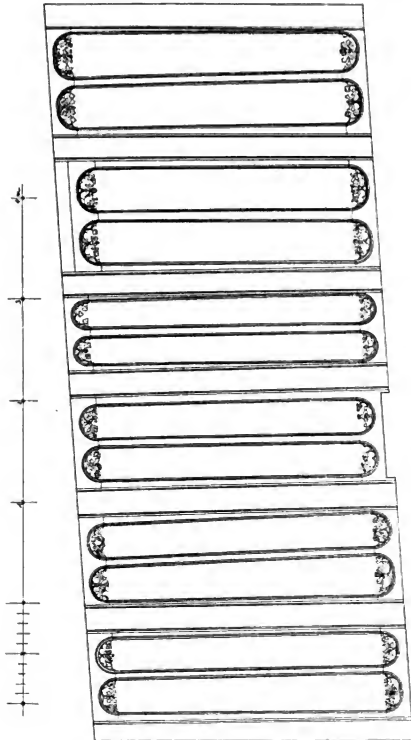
Rathsau; Korkammer, Grundris der Decke.
